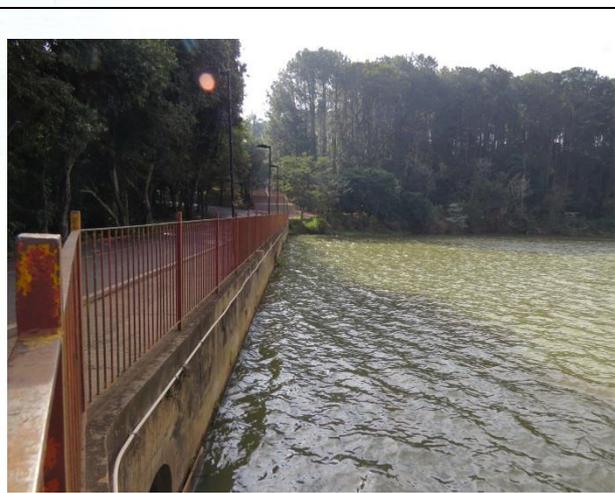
Vista da barragem e via de circulação dentro do campus da UFSCAR. Notar dimensões e extravasores.
